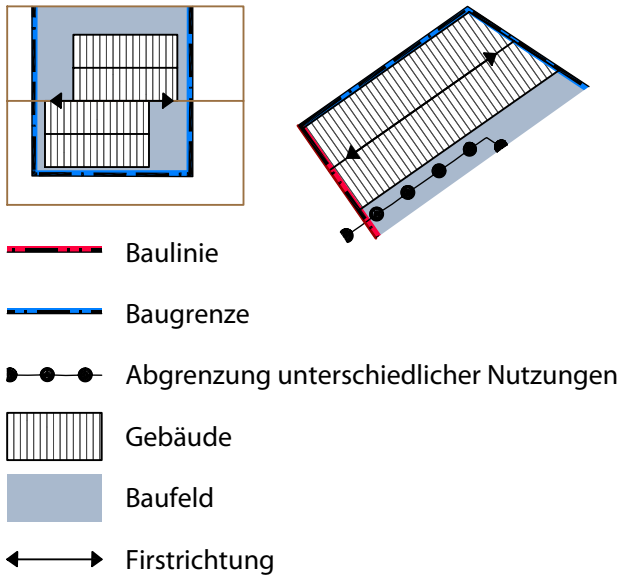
Erklärung Festsetzungen Bebauungsplan - Zeichnung
